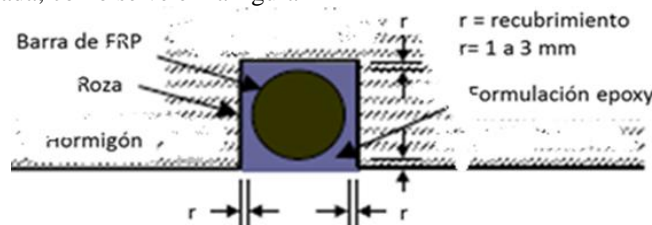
Corte transversal de la sección reforzada, mostrando el detalle de una barra de refuerzo.
